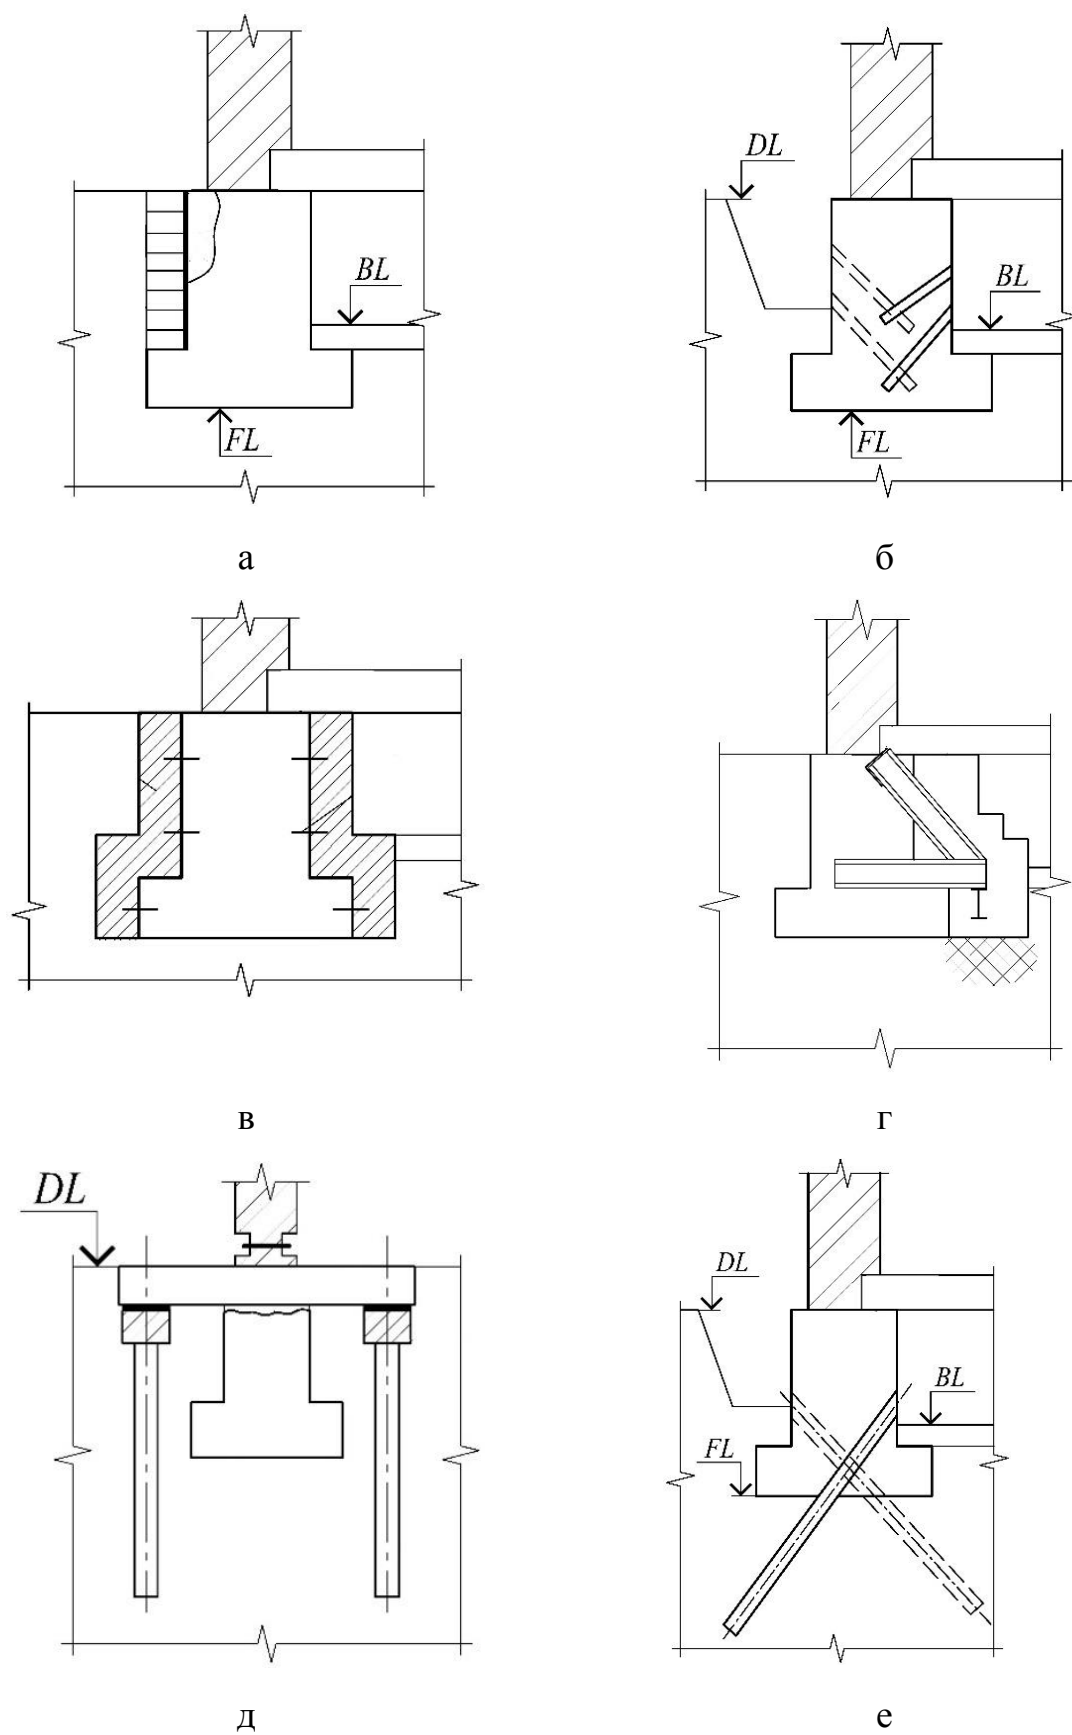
Способы усиления бутового фундамента [33]
